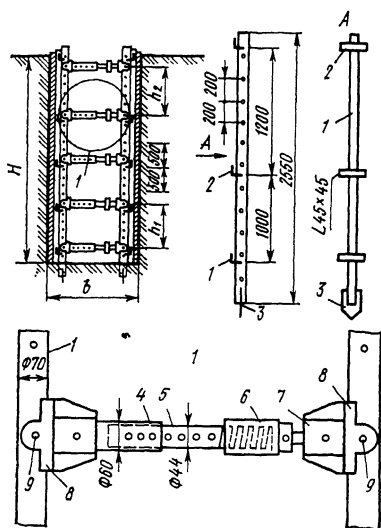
Временное крепление вертикальных стенок траншей с применением инвентарных трубчатых стоек и распорок
